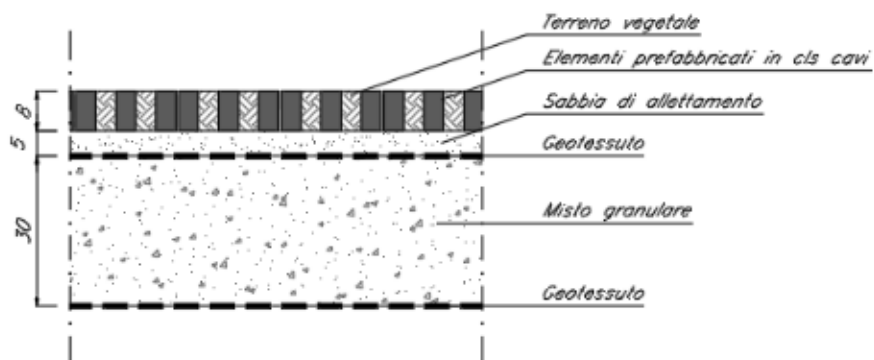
Dettaglio 2, pacchetto pavimentazione stalli
